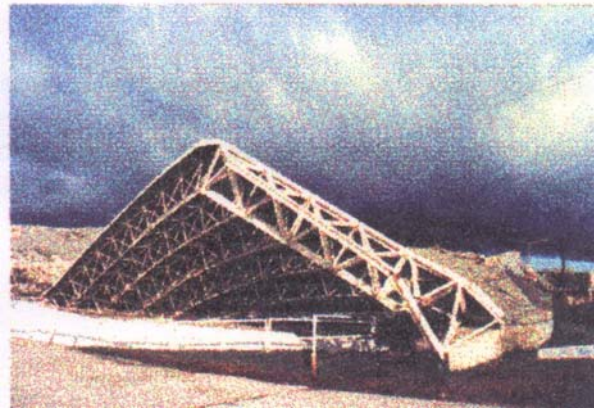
Estructura metálica destruida por el temporal ocurrida el día 28/04/92
